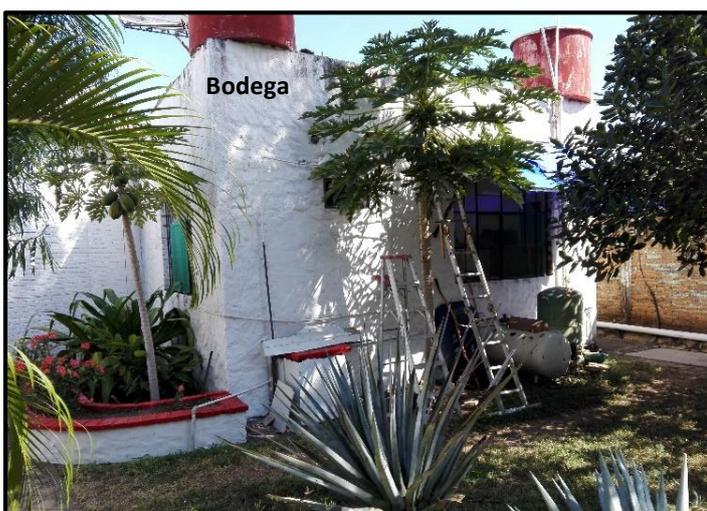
Construcción tipo cónica, plancha de concreto, rampa y escalones de acceso al cono, bodega y baños contiguos al cono.
